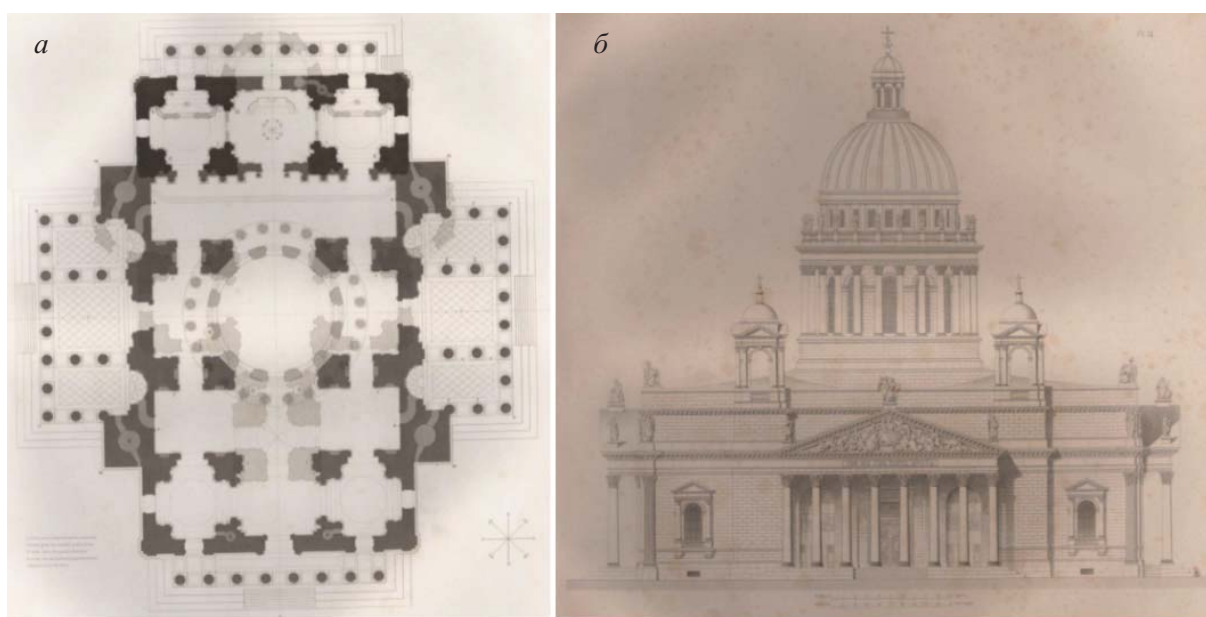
О. Монферран. Проект Исаакиевского собора: а - план 1825 г.; б - фасад, вариант 1835 г. [5].
